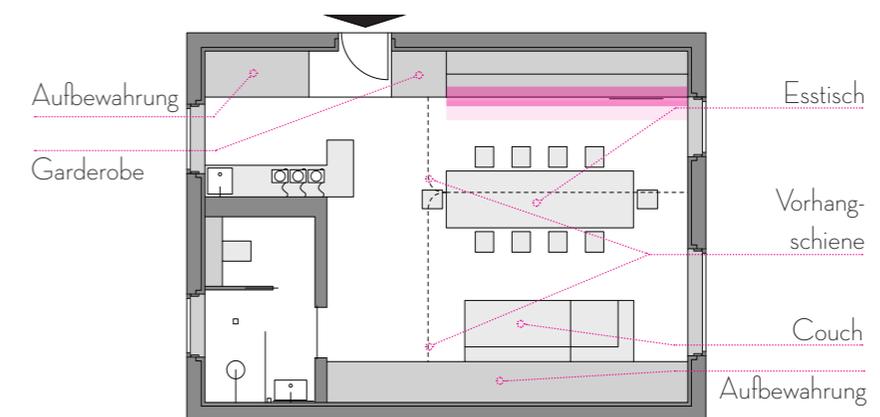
Grundriss:: Variante für ein Zimmer
